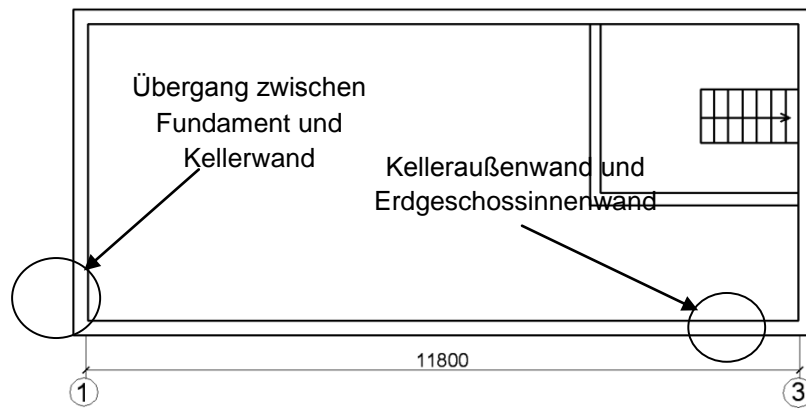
Das Fünfzigjahre Siedlungshaus: Grundriss Kellergeschoss
